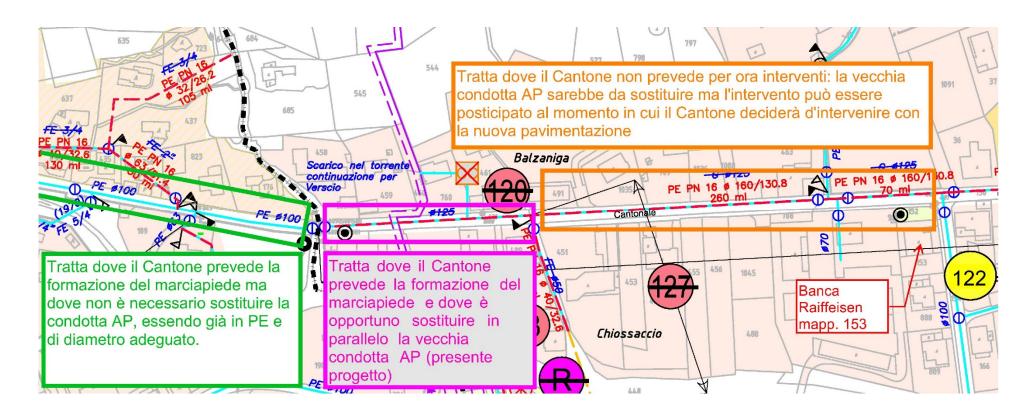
Estratto da piano di PGA [1], intervento no. 122 in strada cantonale, concetto d'intervento nell'ambito del progetto cantonale per il marciapiede [2]: nel riquadro rosa la tratta oggetto del presente progetto di sostituzione della condotta AP.
